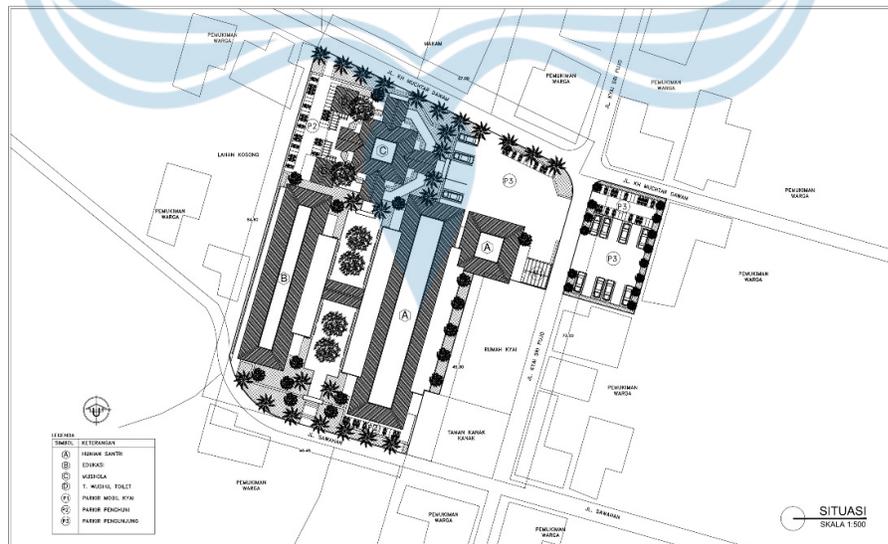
Lokasi Pondok Pesantren Assalafiyah I.
